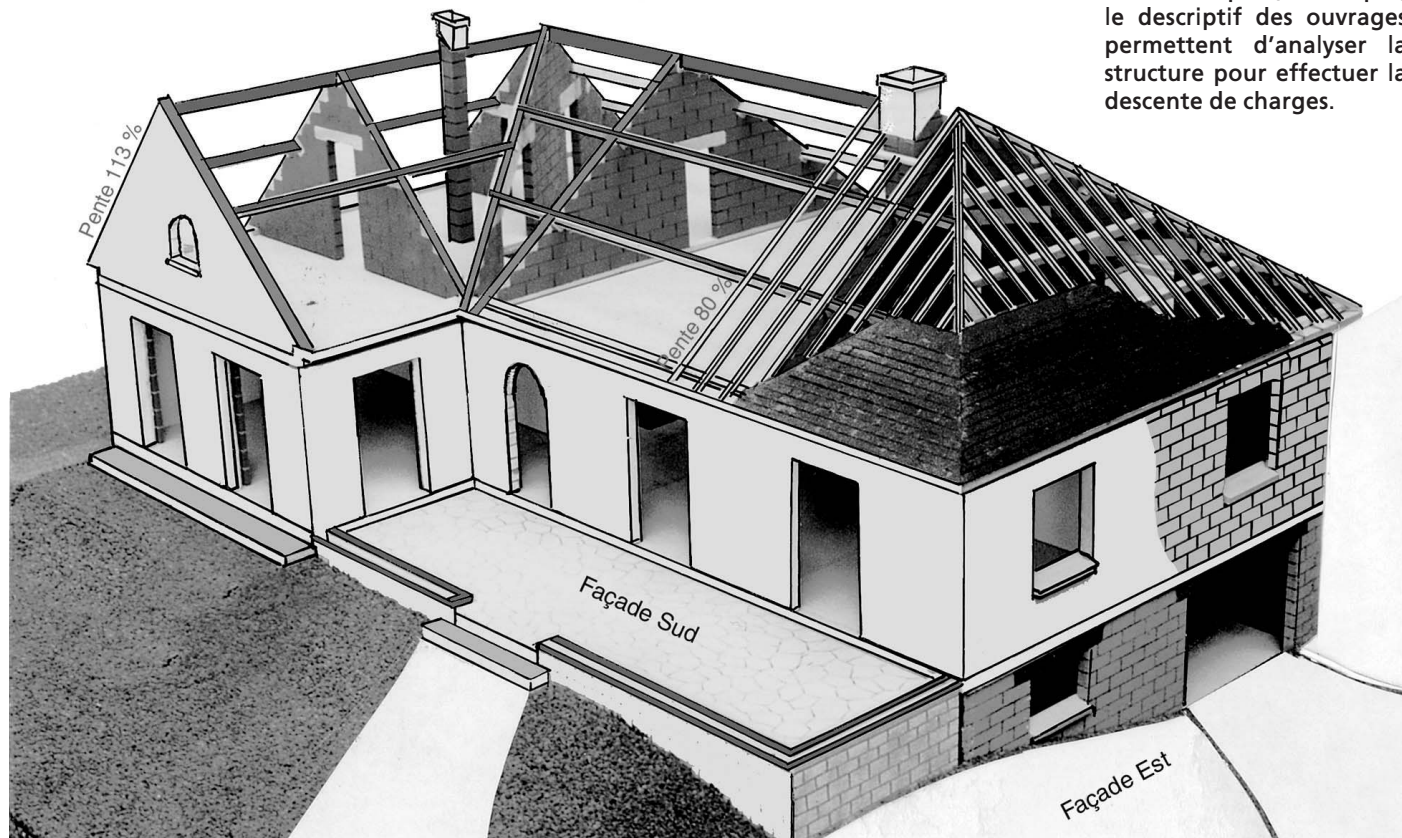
Maquette du pavillon avec sous-sol, rez-de-chaussée et combles aménagés
